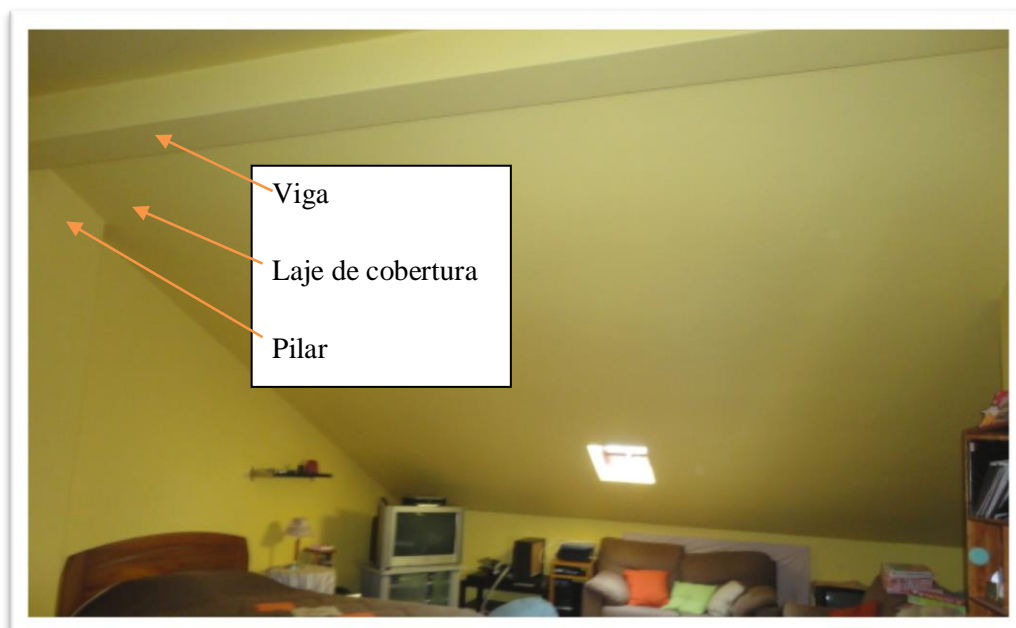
Arrecadação - localização do pilar, viga e laje de cobertura
